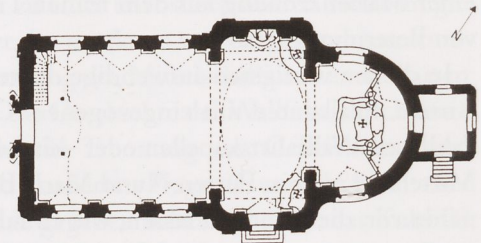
Haigerloch, Wallfahrtskirche St. Anna,
